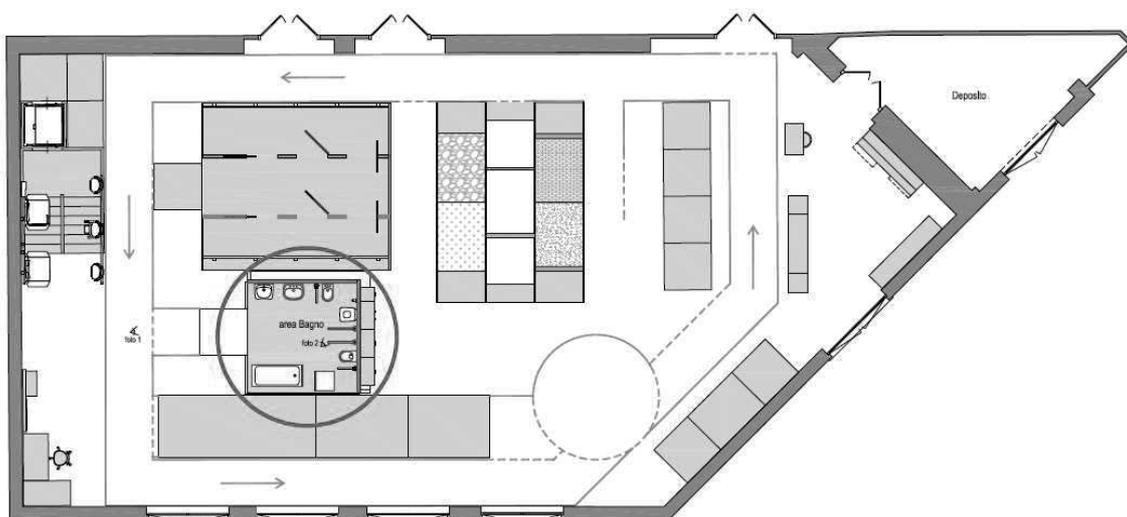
Planimetria Palestra di AUSILIA - Area Bagno
